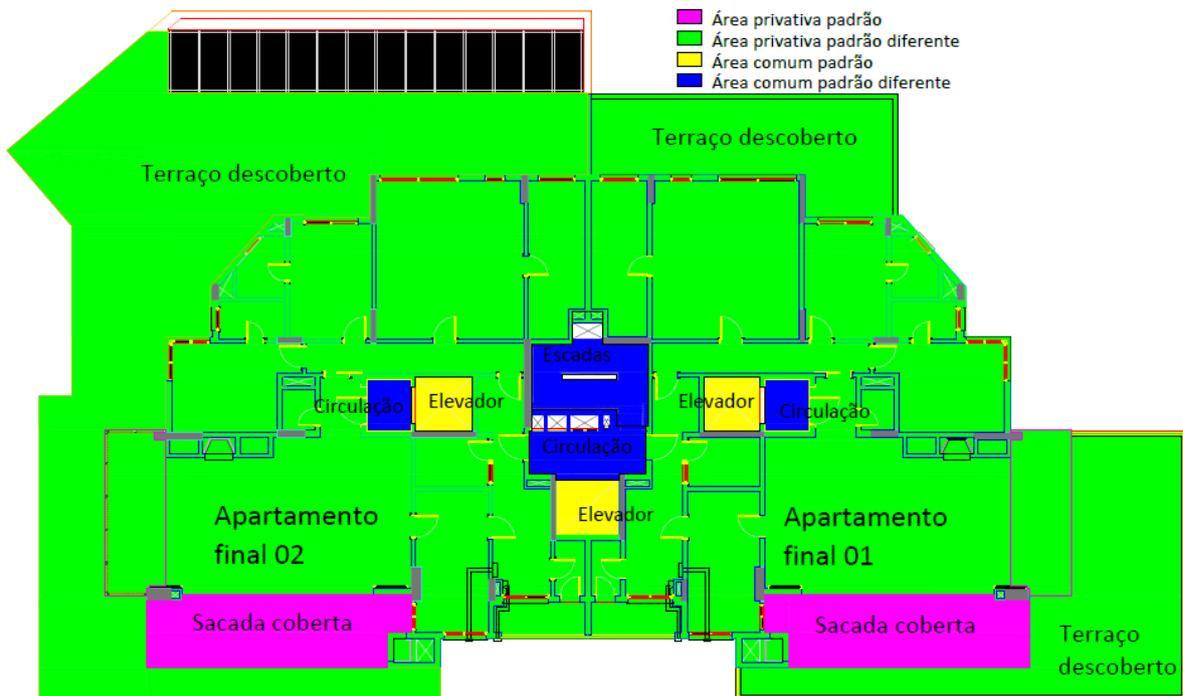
Divisão de áreas do pavimento térreo do Projeto A
